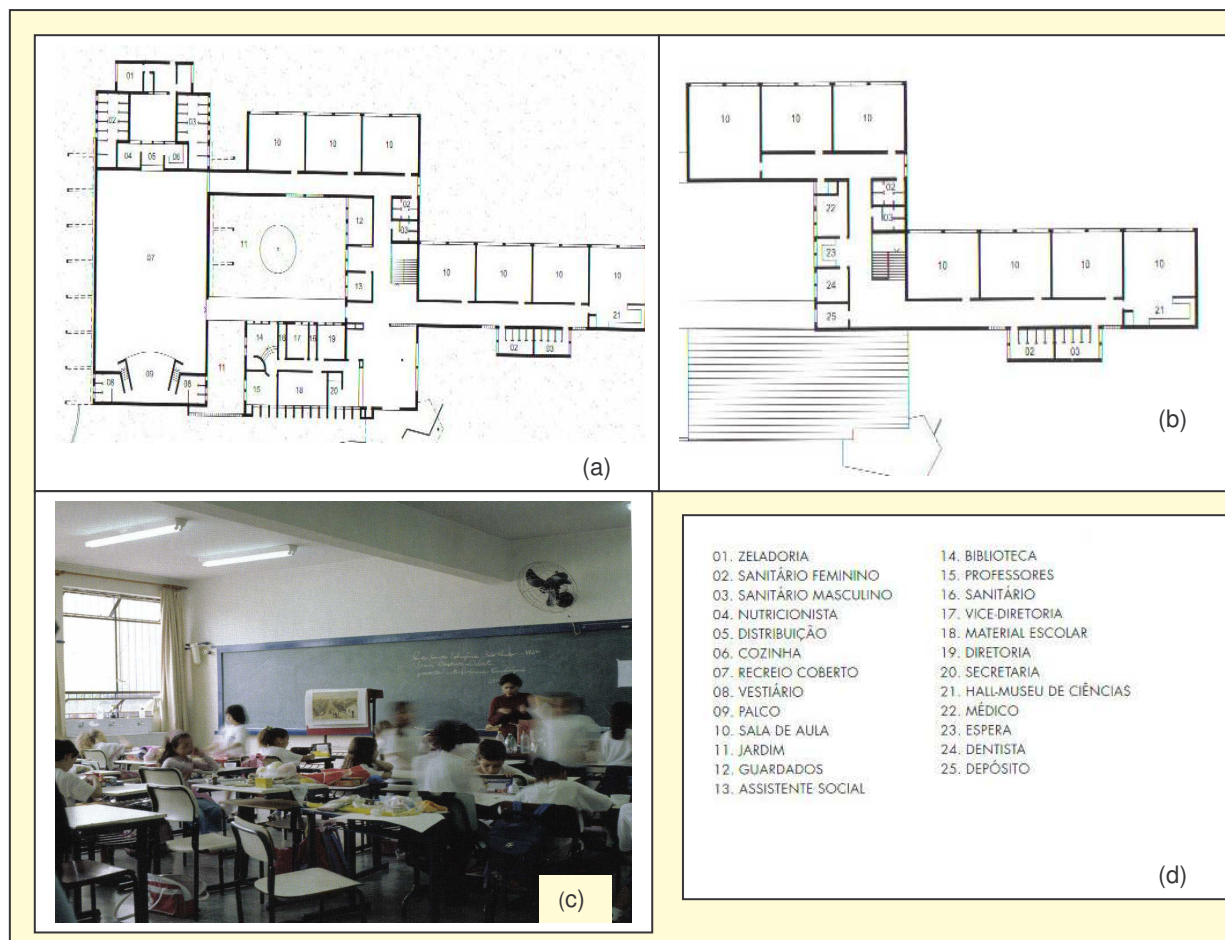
Grupo Escolar Pandiá Calógeras (1951) de autoria de Hélio Duarte. Em (a): da planta baixa do pavimento térreo; (b): planta baixa do pavimento superior; (c): foto de uma sala de aula; (d): legenda. Atual EE Pandiá Calógeras.
